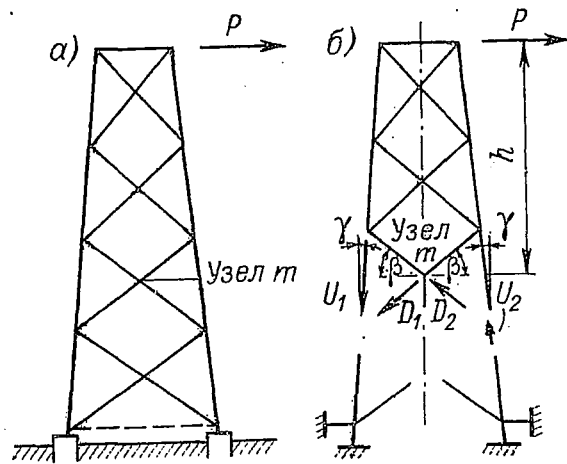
Расчетная схема для определения усилий в ферме с перекрестной решеткой
